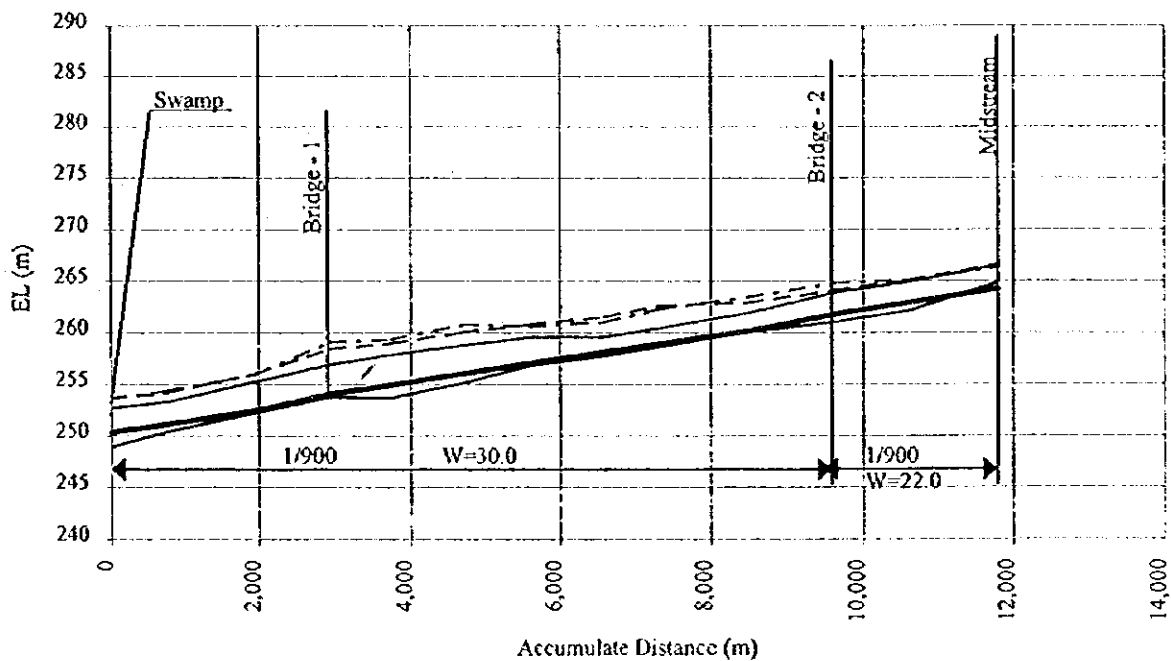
(2) PERFIL LONGITUDINAL DEL ARROYO YAPACANICITO Y JOCHI
